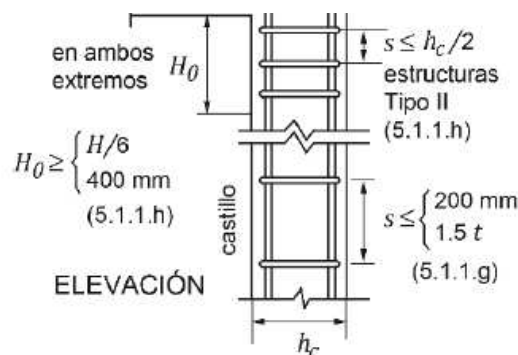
Espaciamiento mínimo del refuerzo transversal, columna de confinamiento.
